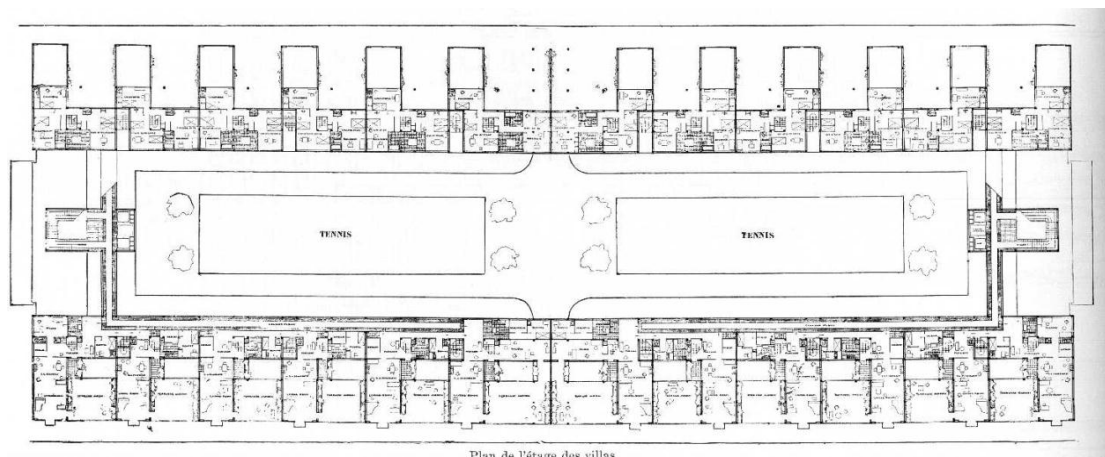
Planta do conjunto da *Immeuble-Villa
